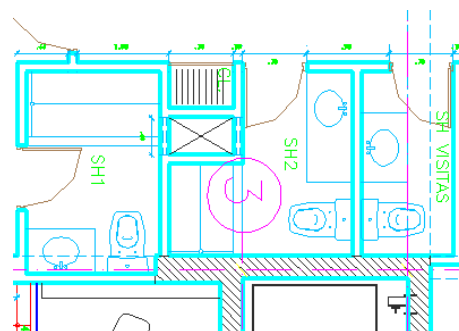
Planta del Primer Nivel – “Ubicación de Ductos”
